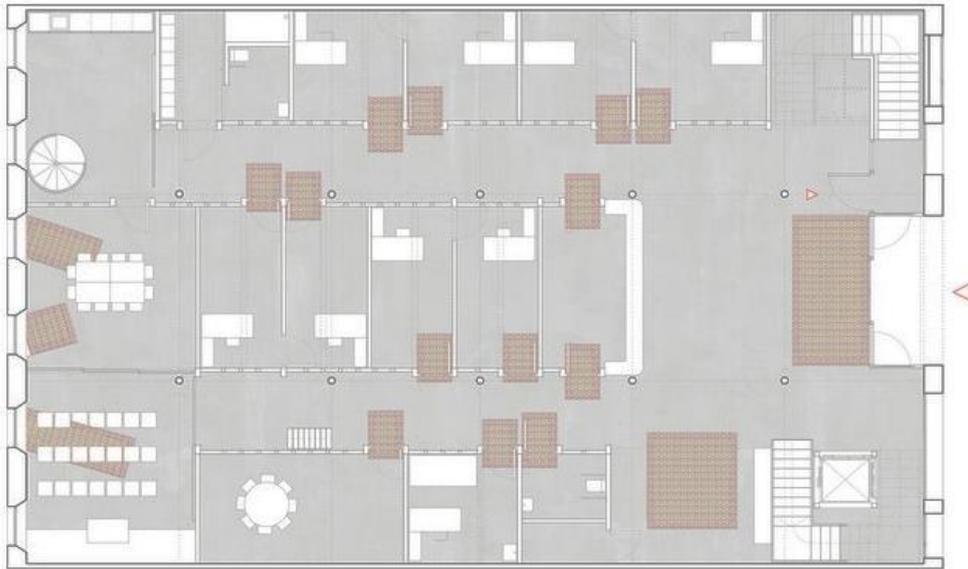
Centro de Drogodependencia Calella. Planta baja general.
